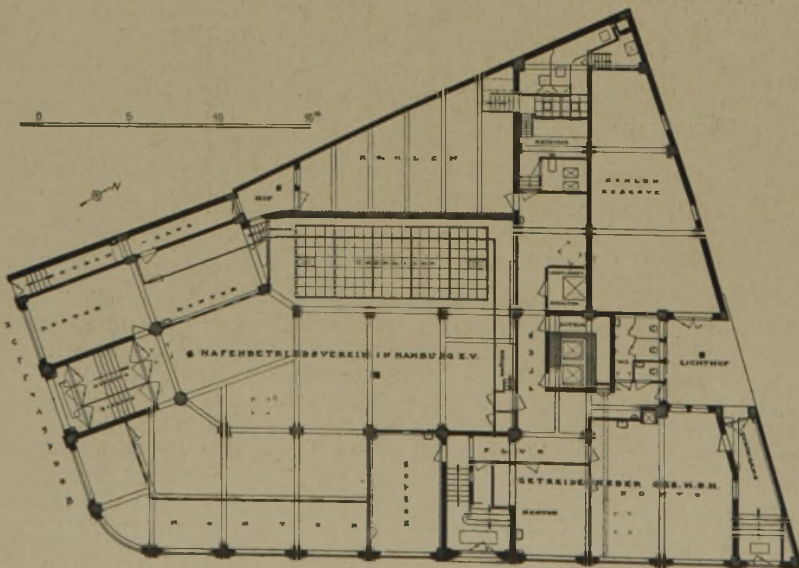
Grundriß des Untergeschosses. (1:400.)
